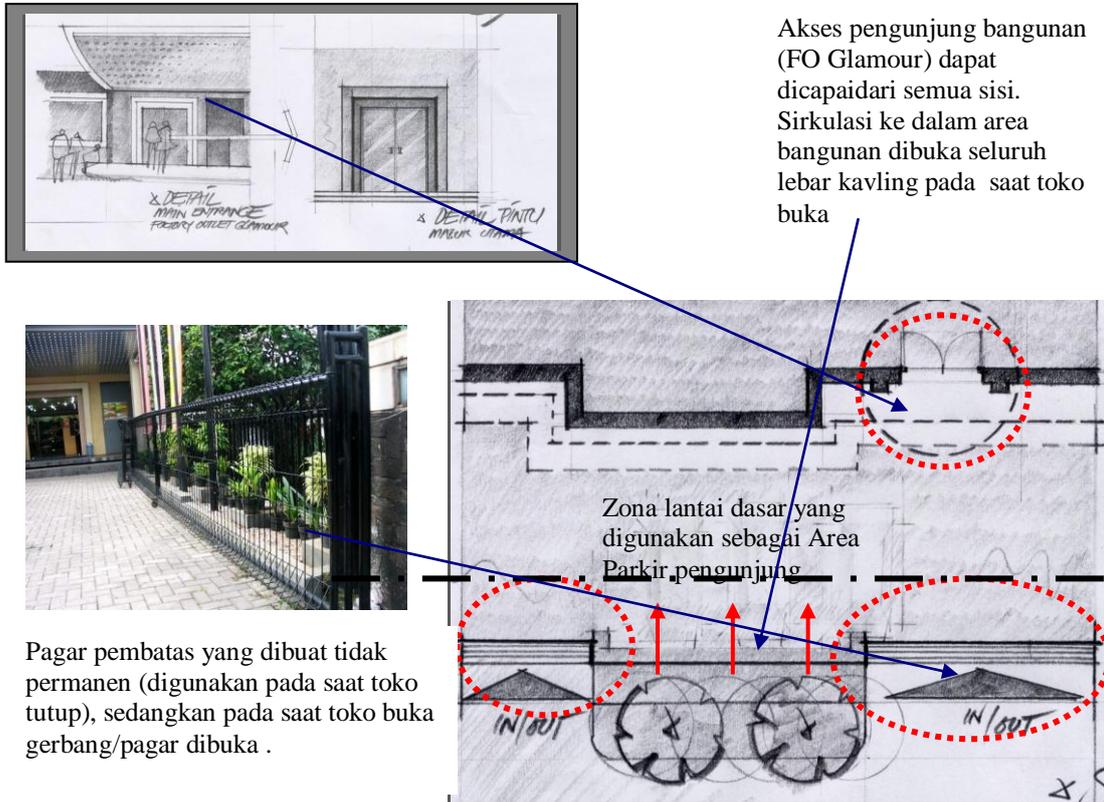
Bukaan pada gerbang bangunan yang meliputi seluruh lebar kavling
